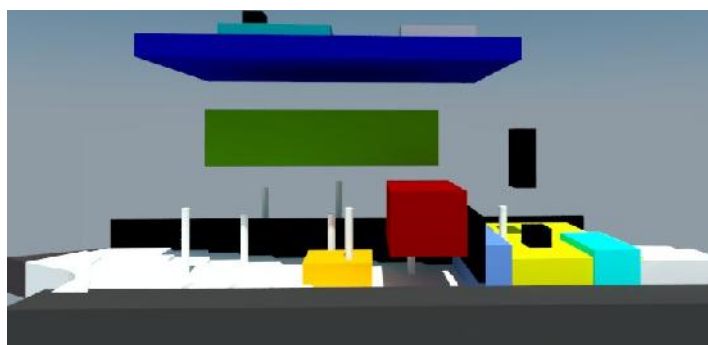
Plan masa conformación de volúmenes vista desde Facha lateral Izquierda.
